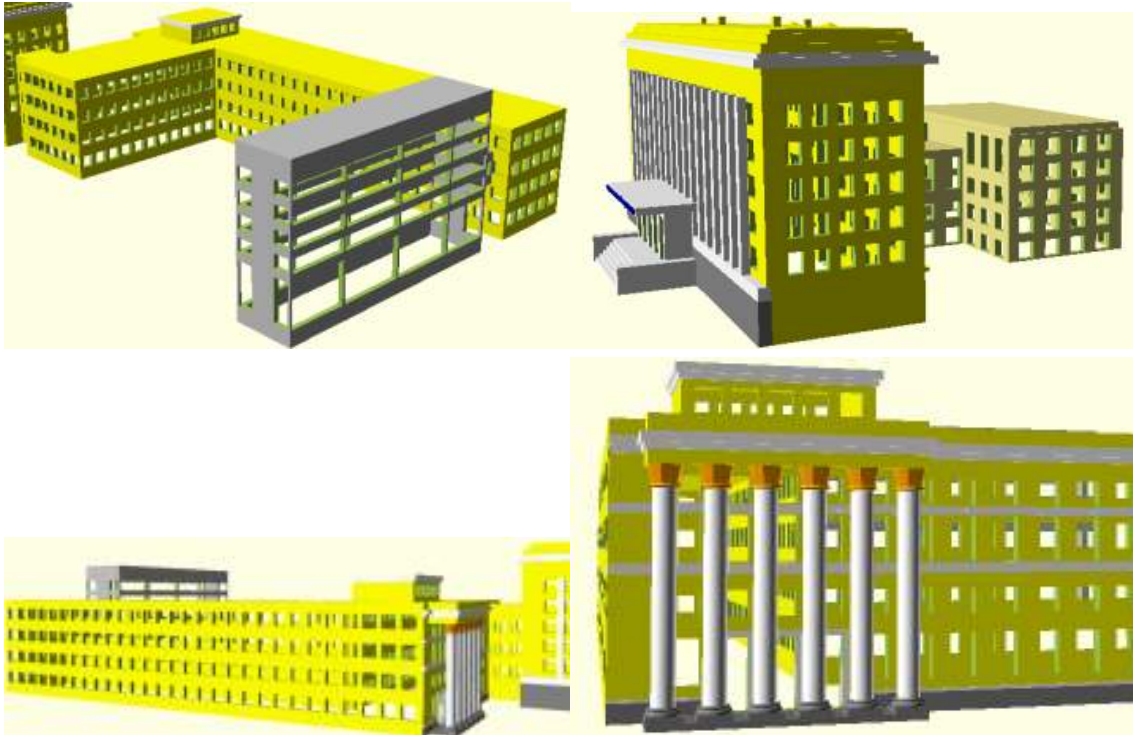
Фасад і торцеві частини корпусу приймальної комісії та корпус А
